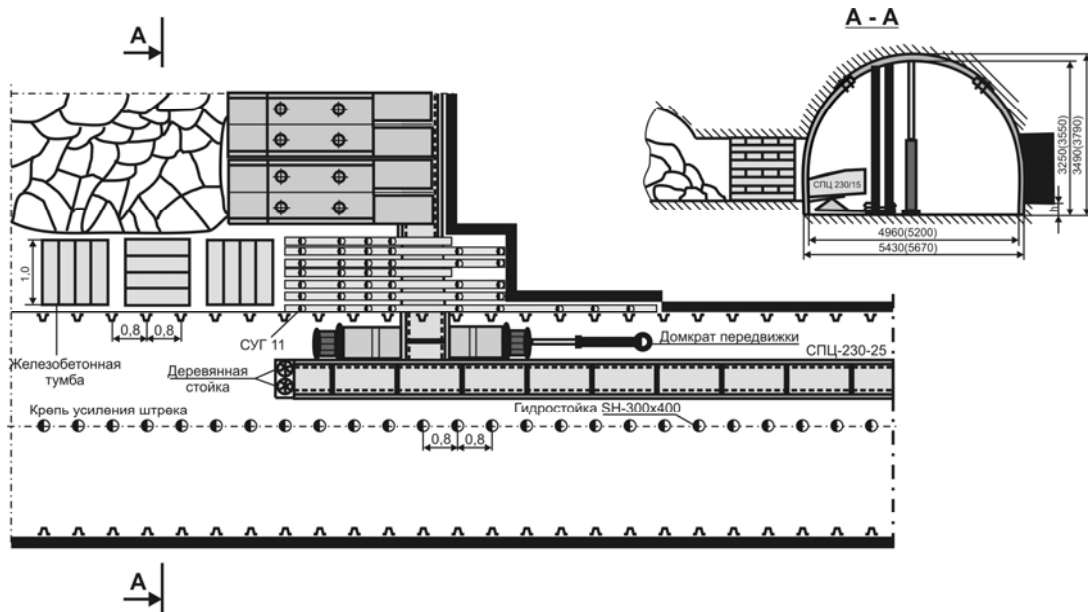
Охрана штрека железобетонными (газобетонными) тумбами
